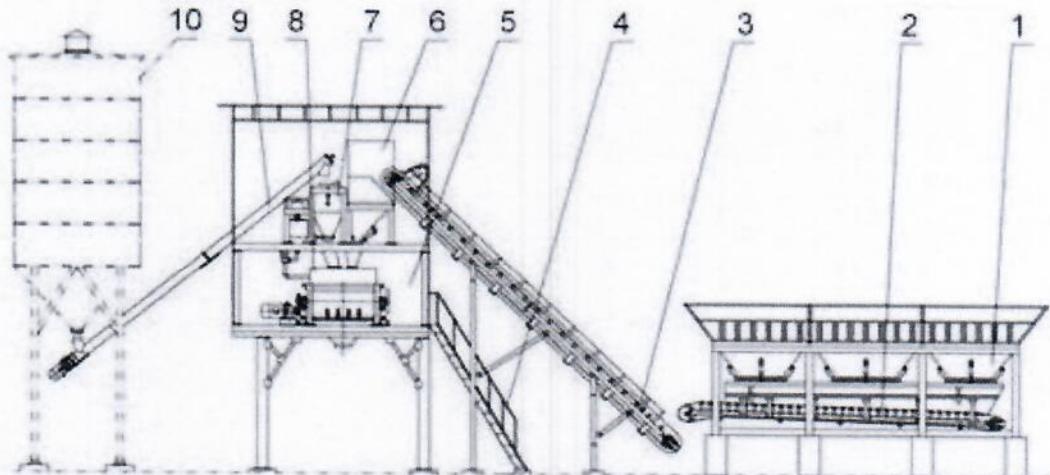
Planta de fabricación de hormigón modelo HZS120
